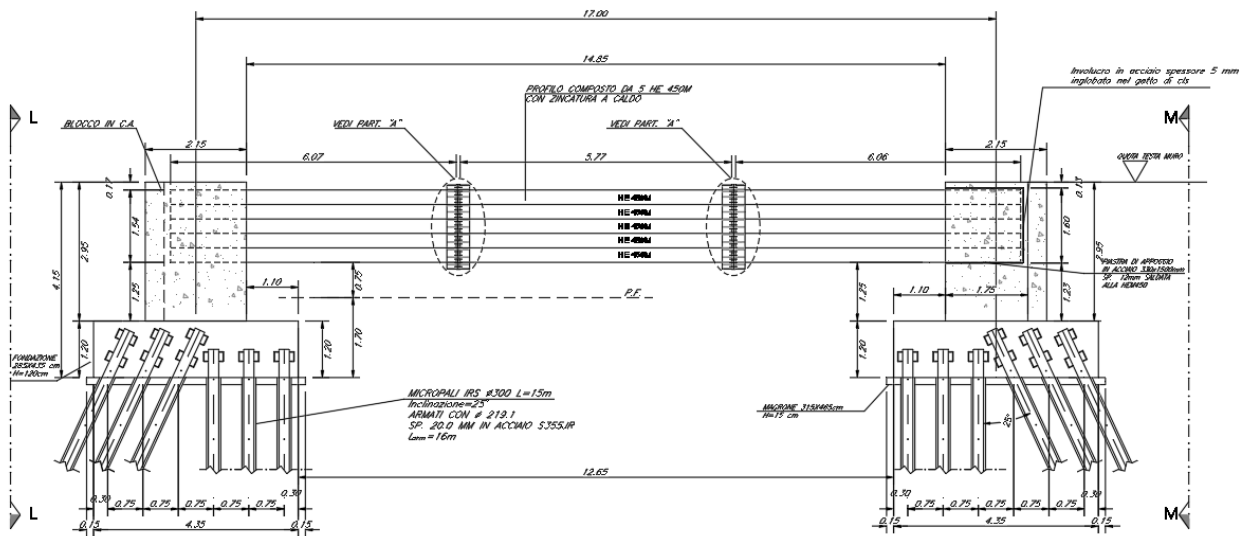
MU03 - prospetto generale muro opera di protezione con luce asse-asse di 17.00 m
